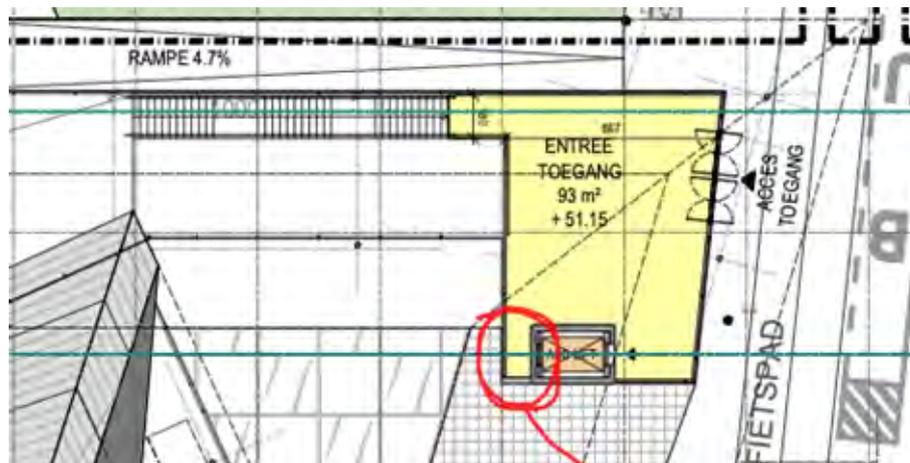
Localisation de la zone de recoin au rez-de-chaussée du pavillon « Grand Bordet » (Tractebel sur fond de plan BMN)
